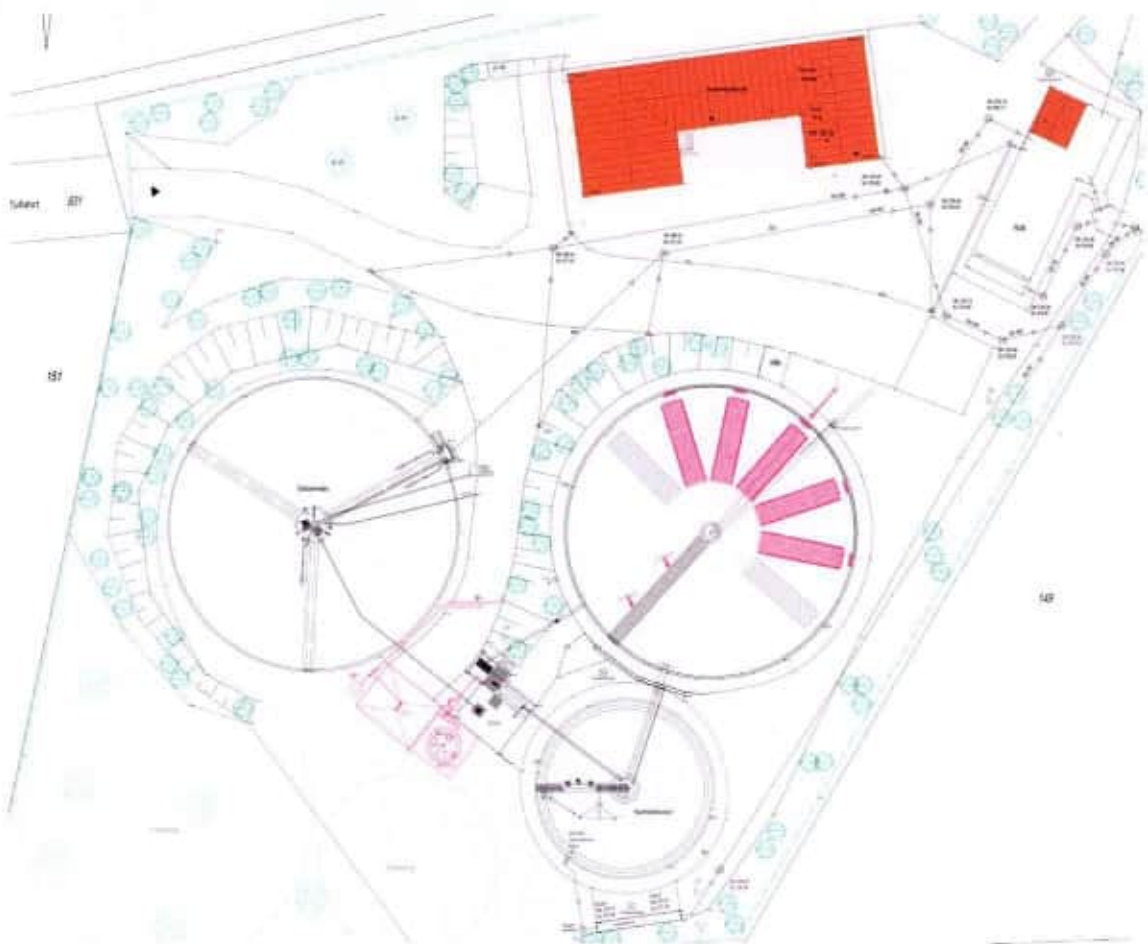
Auszug aus dem Lageplan mit baulichen Erweiterungen bzw. Ertüchtigungen
